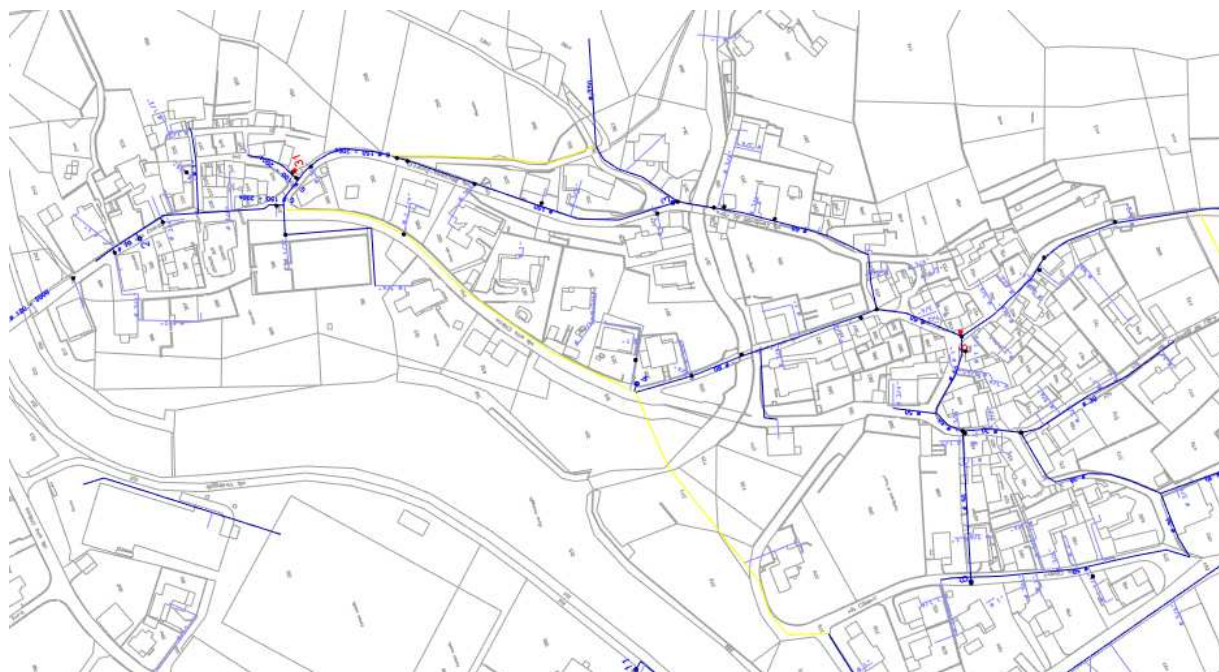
Estratto planimetria acqua potabile quartiere Camignolo
